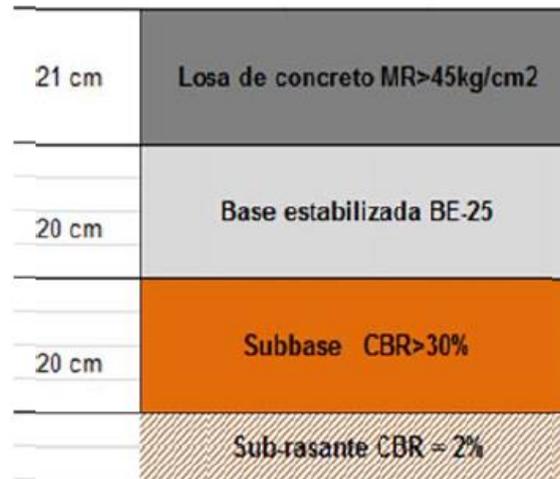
Composición de la sección de pavimento en vías marginales.
